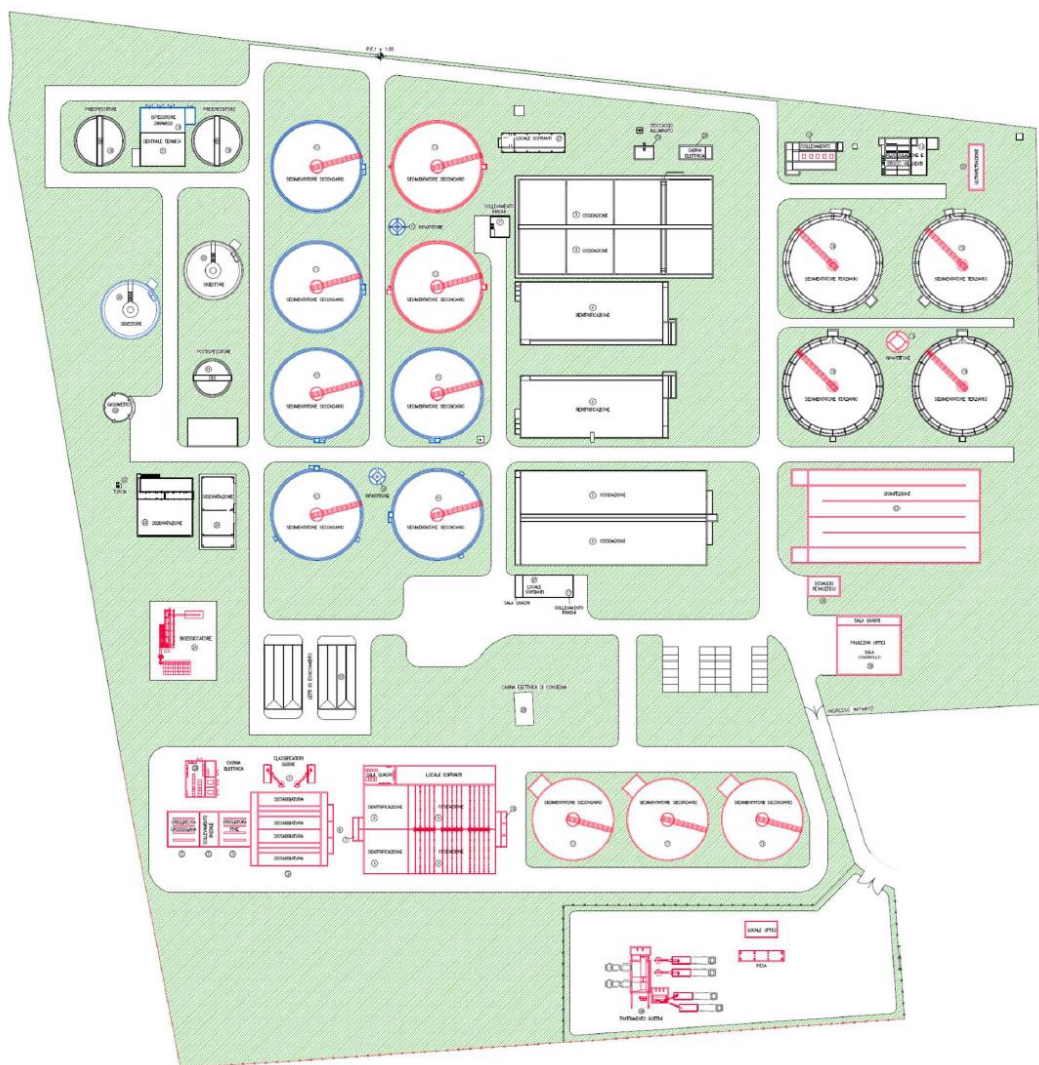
Layout stato di progetto depuratore di Ravenna nella configurazione dell'alternativa 1
